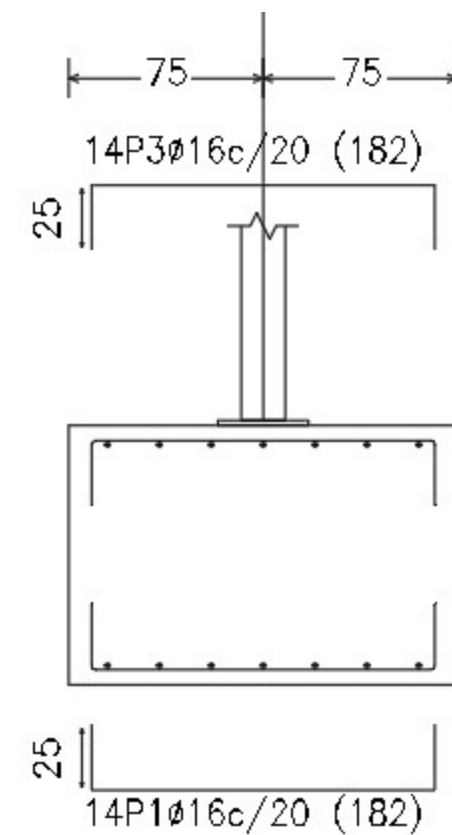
Vista lateral de una de las zapatas que compone la cimentación de la cubierta
